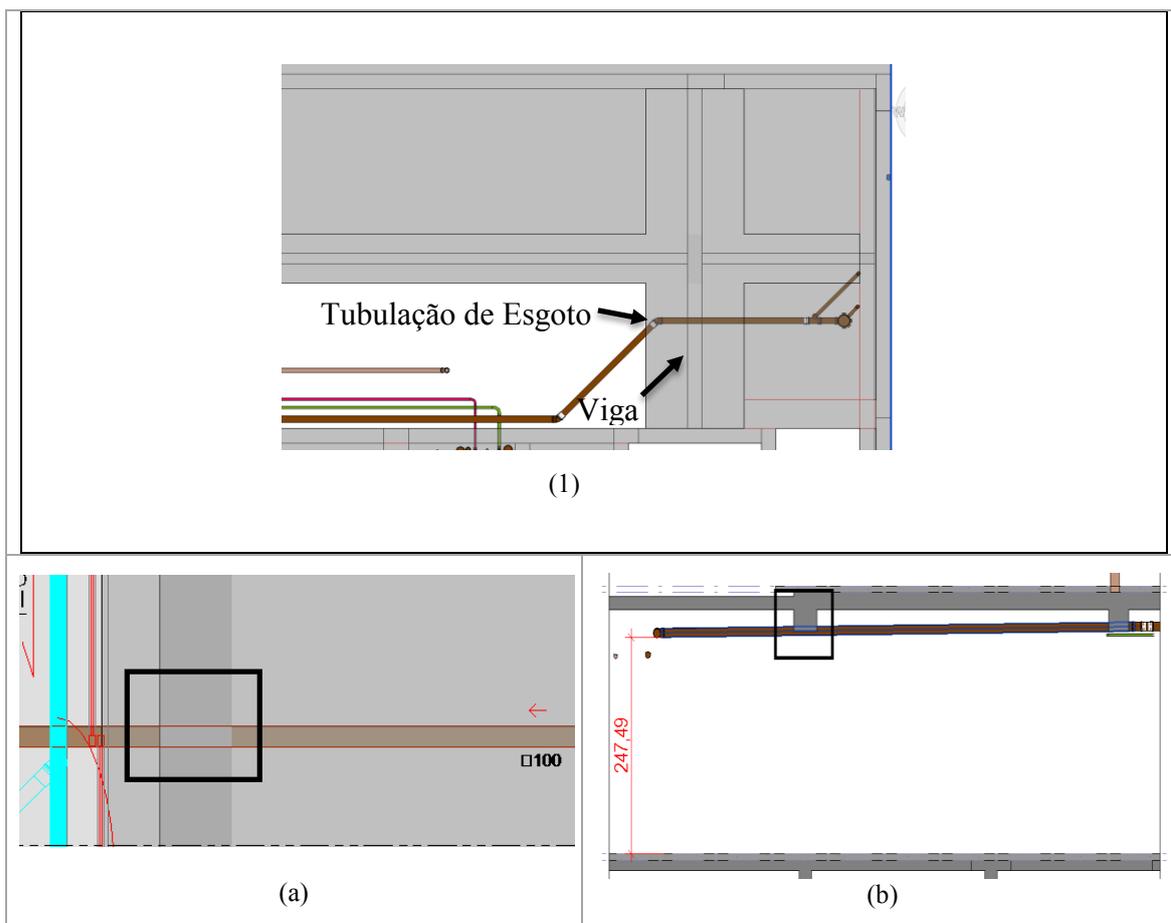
Planta baixa de viga em confronto com tubulação de esgoto (a) e vista frontal da viga em questão (b). Fonte: elaborado pelos autores
